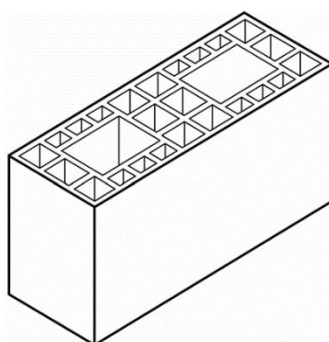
Bloco cerâmico estrutural: NBR 15.270-1 (ABNT, 2023).
